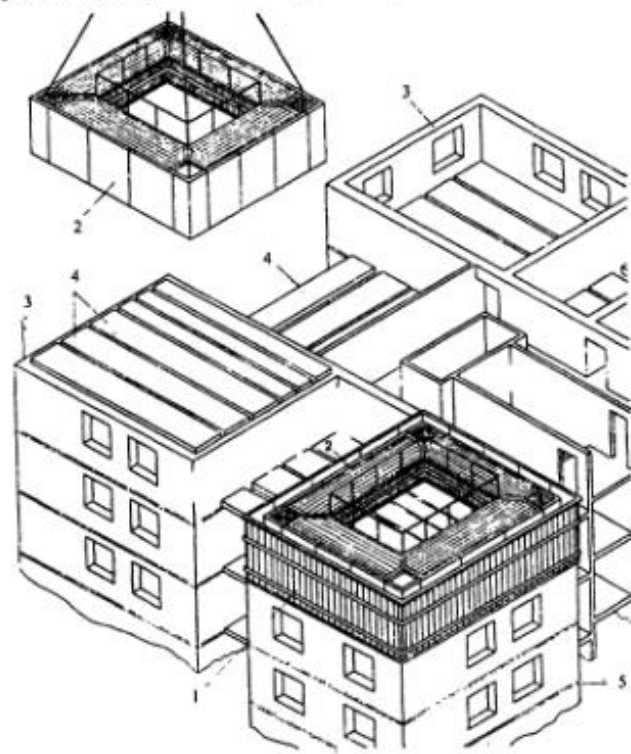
Возведение здания в крупнощитовой и блочной опалубках: 1 - крупнощитовая опалубка, 2 - блочная опалубка, 3 - монолитная стена; 4 - сборные плиты перекрытий, 5 - горизонтальный технологический шов наружной стены
